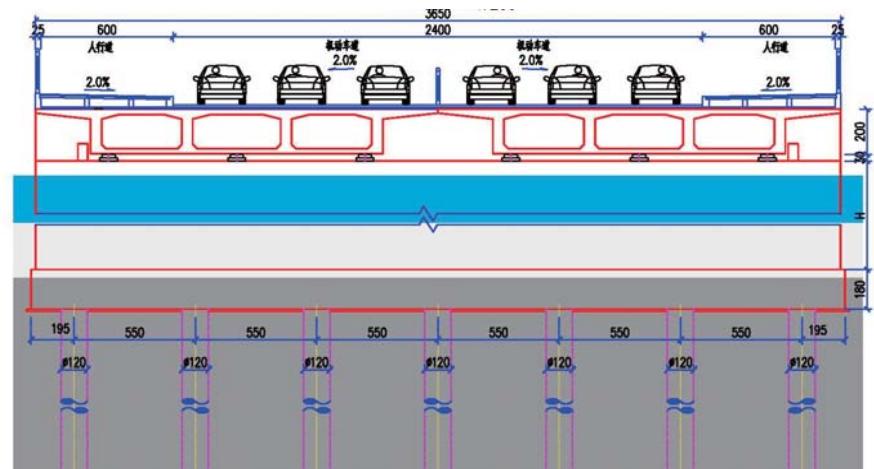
桥梁 B-B 断面图 (单位: cm)
